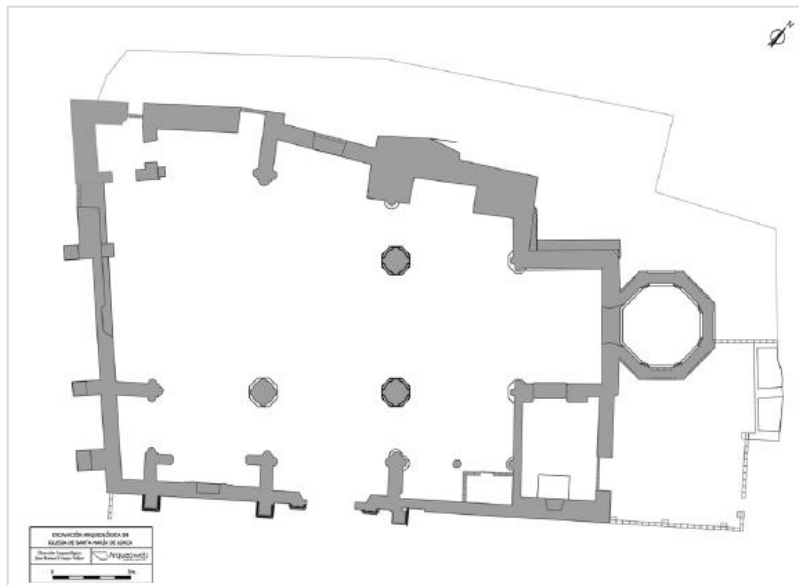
Planta de la iglesia Santa María. Fuente: arqueoweb
